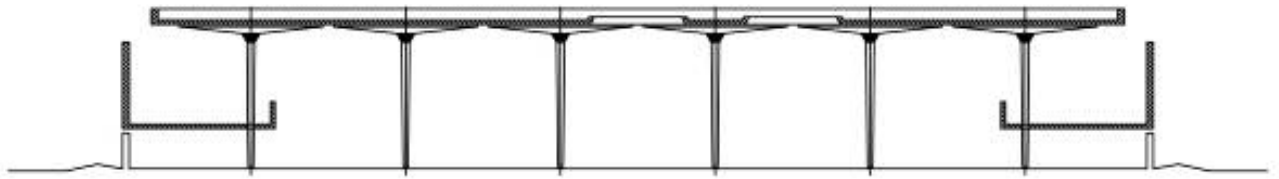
Sección longitudinal sala de trabajo, 6 columnas.
